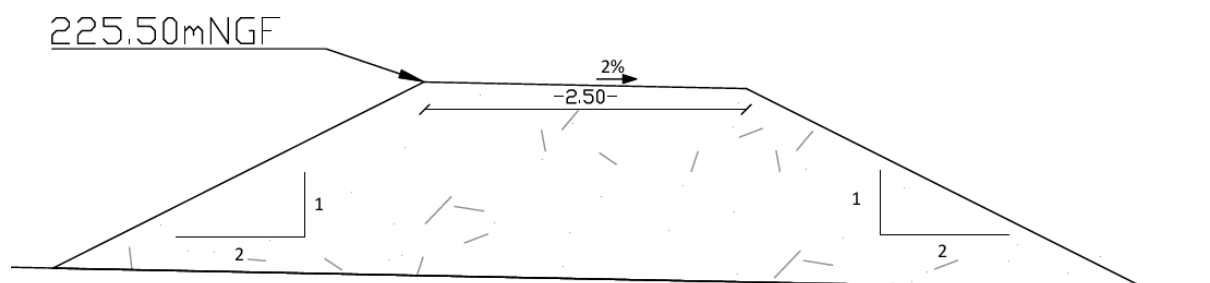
Extrait de la coupe de l'ouvrage OH3
